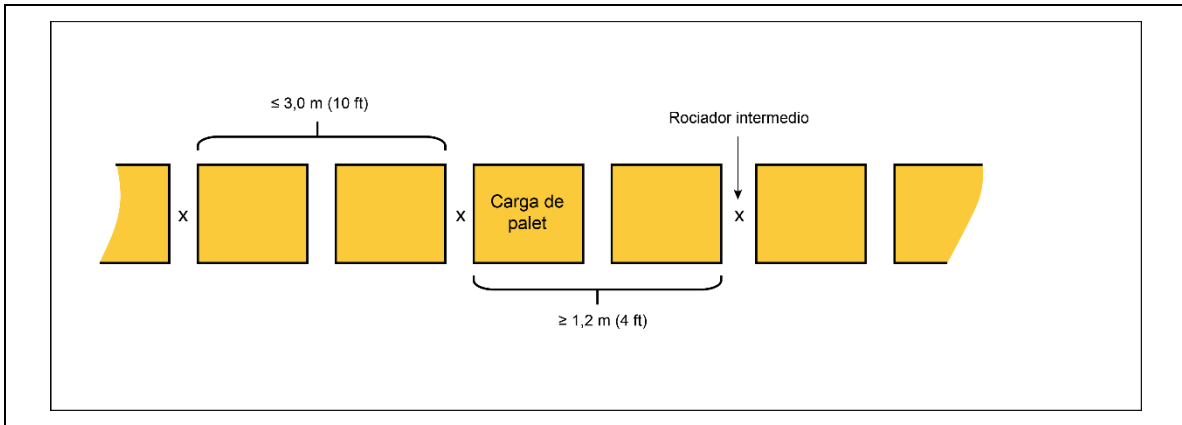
Vista en planta de una configuración horizontal de rociadores intermedios cada dos chimeneas transversales para estanterías simples
